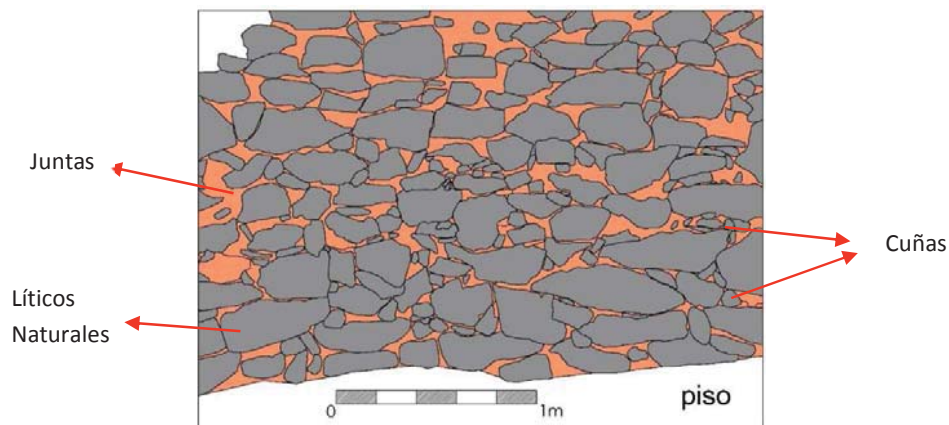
Tipo de mampostería Ordinaria de muro del recintos R13.
